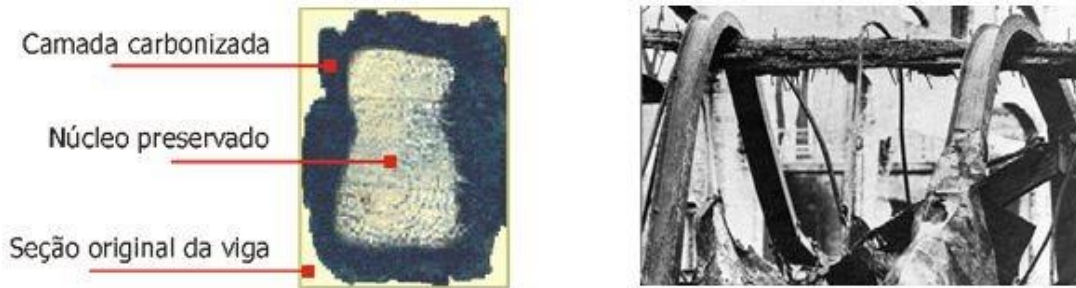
Seção da viga de madeira após incêndio e colapso da viga em aço que é sustentada pela viga em madeira [50]
